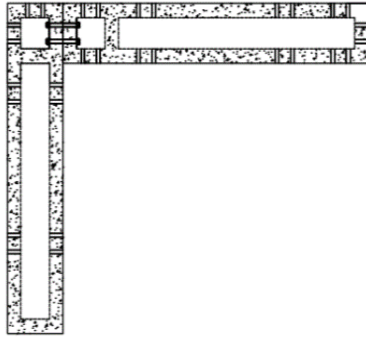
9 Sambungan Balok dengan Kolom lantai 2
